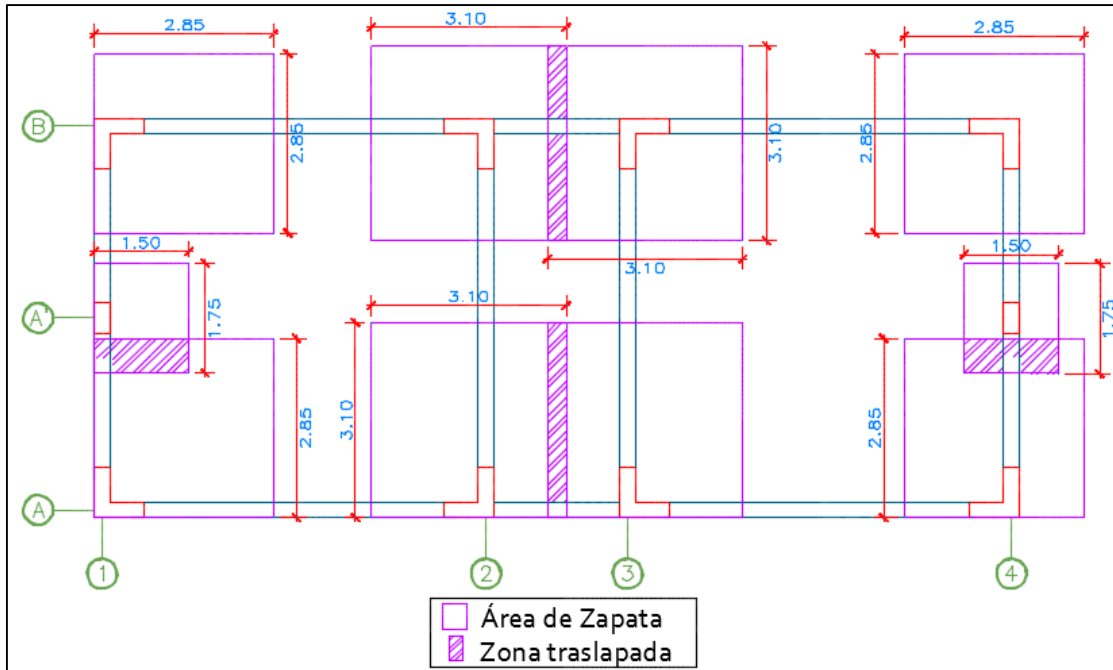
Área de contacto zapata aislada - Sistema aporticado
